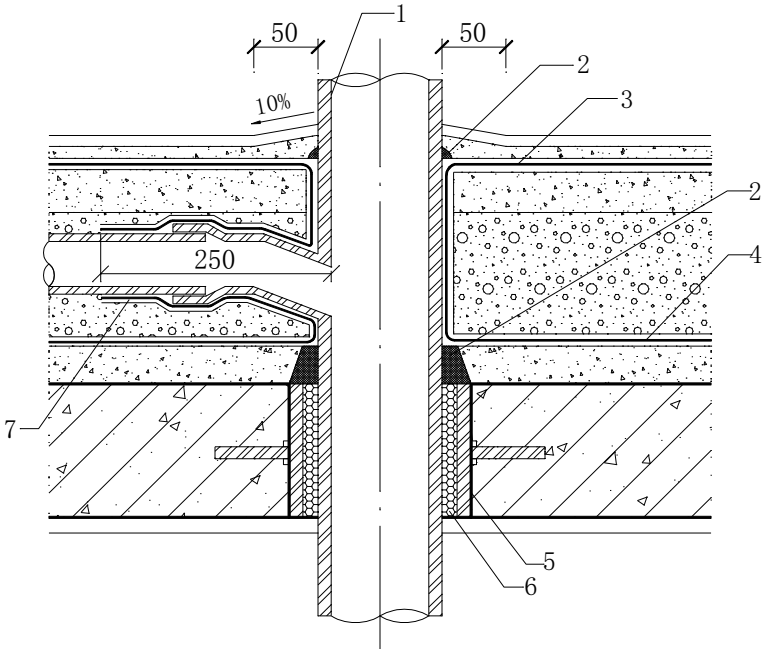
同层排水时管道穿越楼板的防水构造示意图
